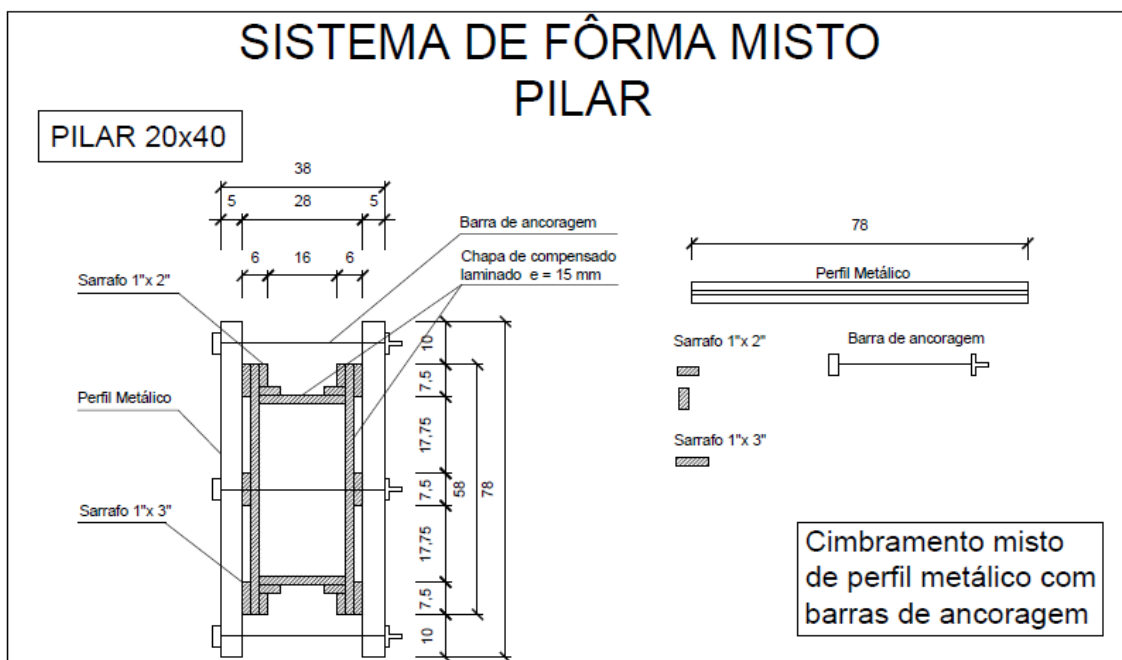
Modelo 01 de fôrma para pilar de concreto armado.
